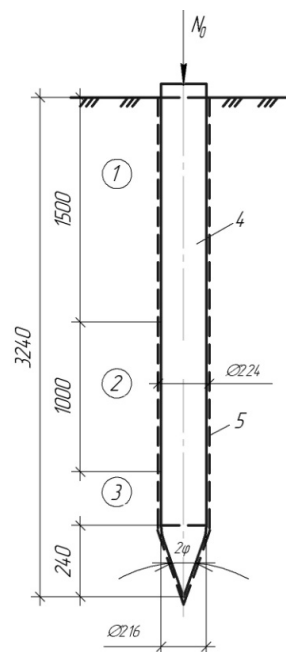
Схема набивной взрывофугасной свай В-2: 1, 2, 3 – слои грунтов; 4 – свая; 5 – грунтоомоноличный слой ствола свай
